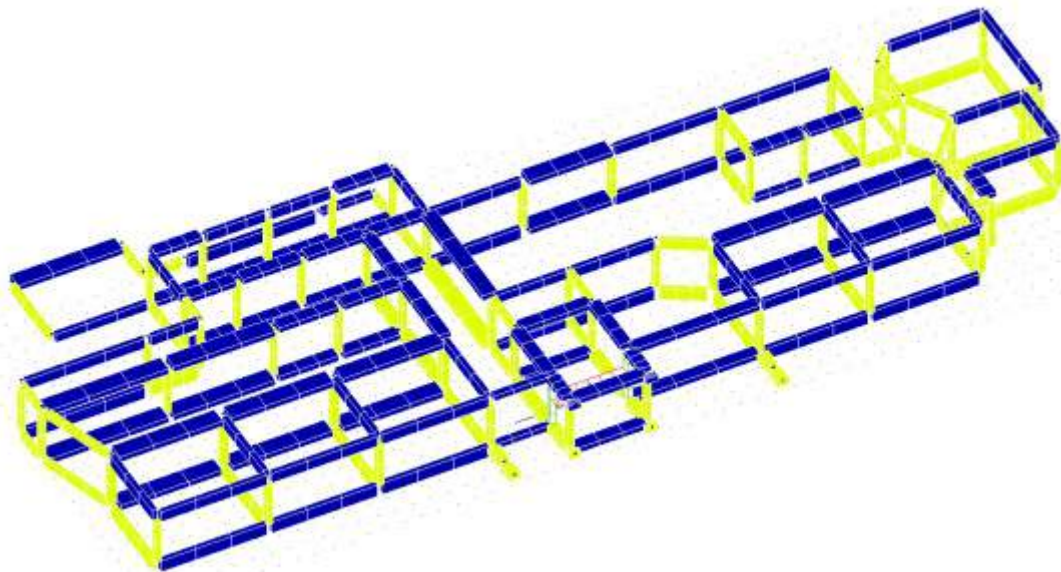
Elementi strutturali oggetto di rinforzo al piano primo (in giallo)
